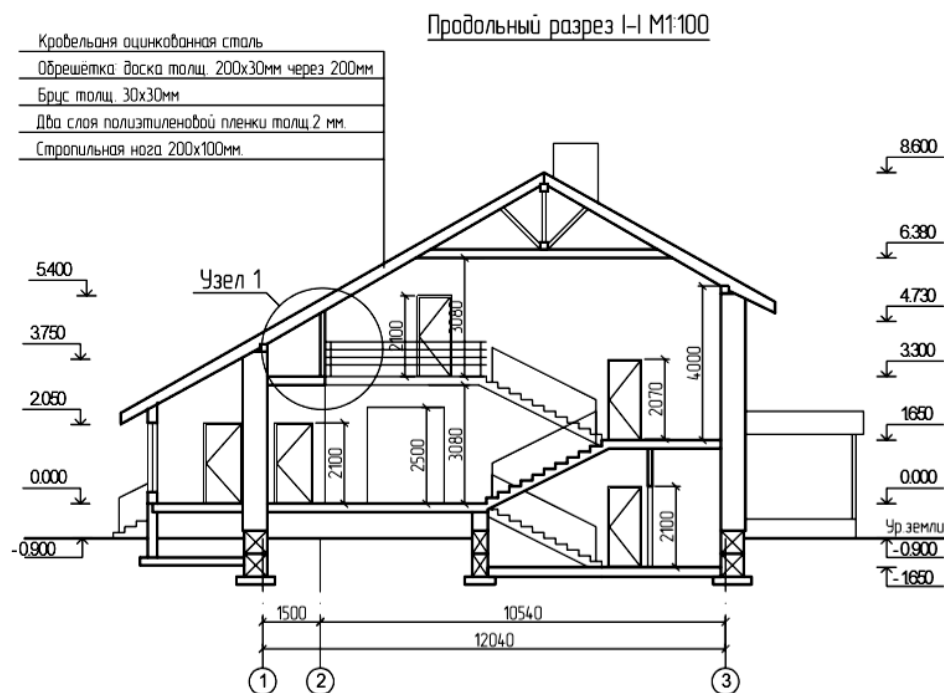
Разрез индивидуального жилого дома с двускатной крышей
